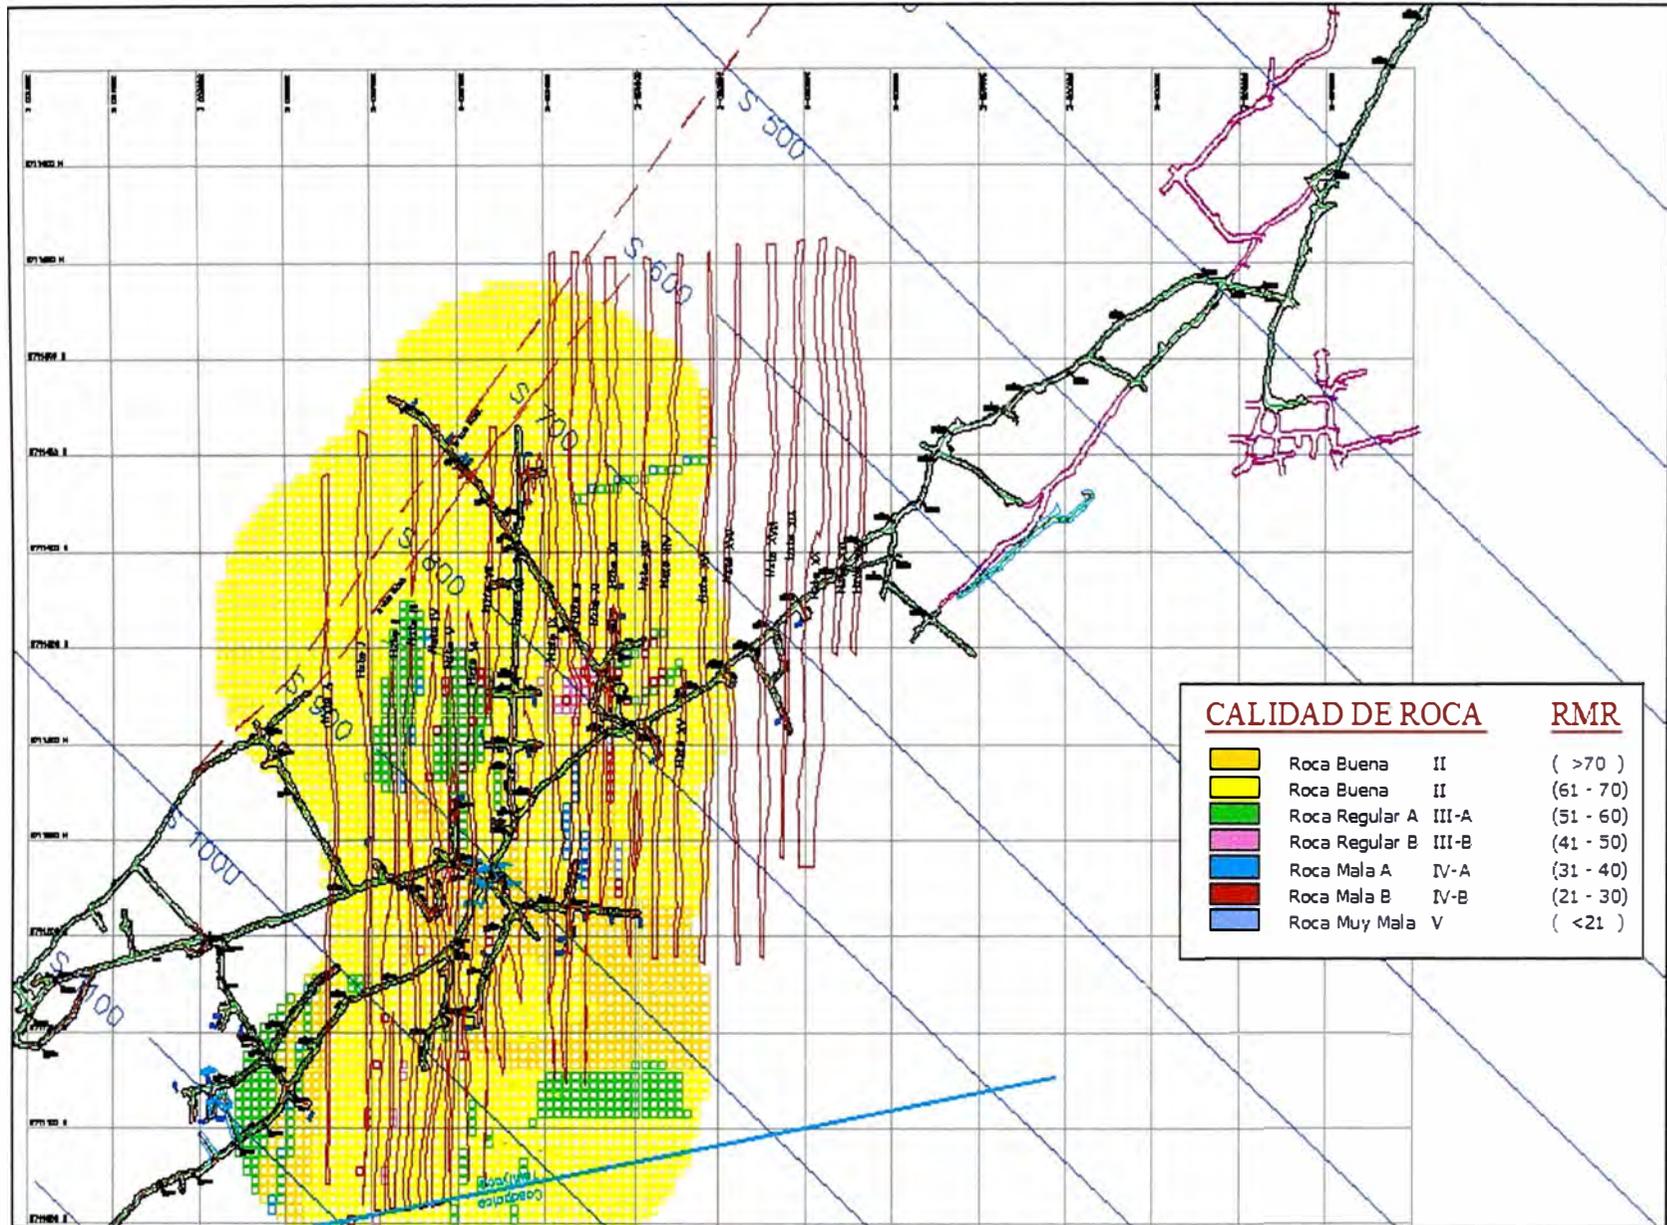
PLANO EN PLANTA DE LA ZONIFICACION GEOMECANICA DEL NV. 3 600 – ZONA HORIZONTES
